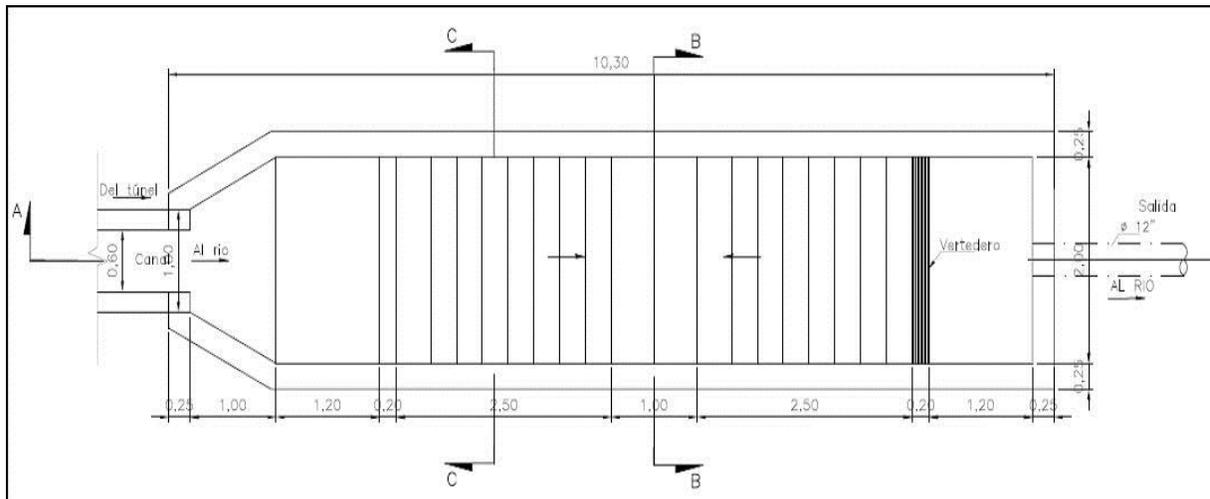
Planta del desarenador para aguas provenientes de la construcción del túnel
